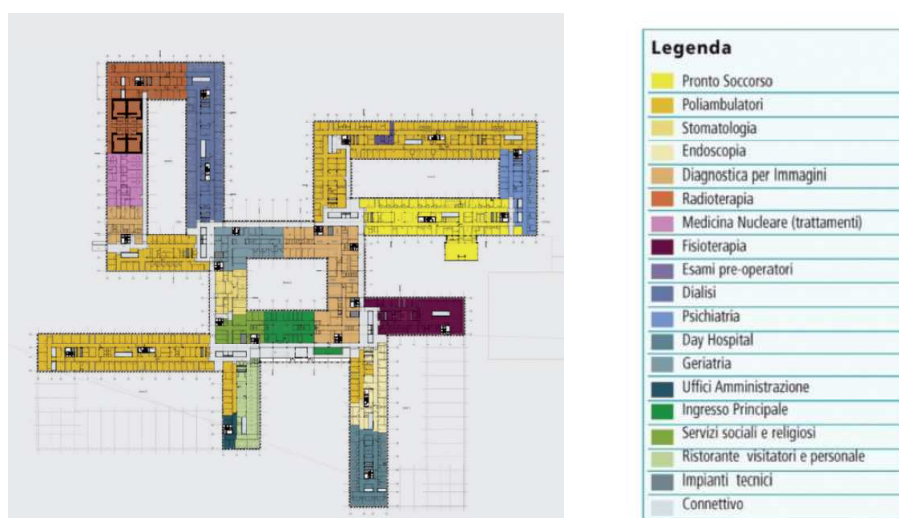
pianta del pianterreno. (Fonte: Baumschlager-Eberle Architekturbüro e FDA Architecten & Ingenieurs).
